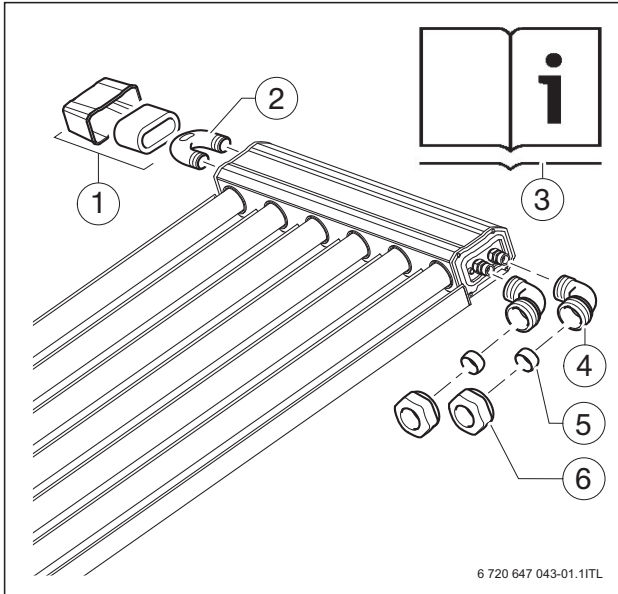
Lieferumfang Anschluss-Set SKR Flachdach
